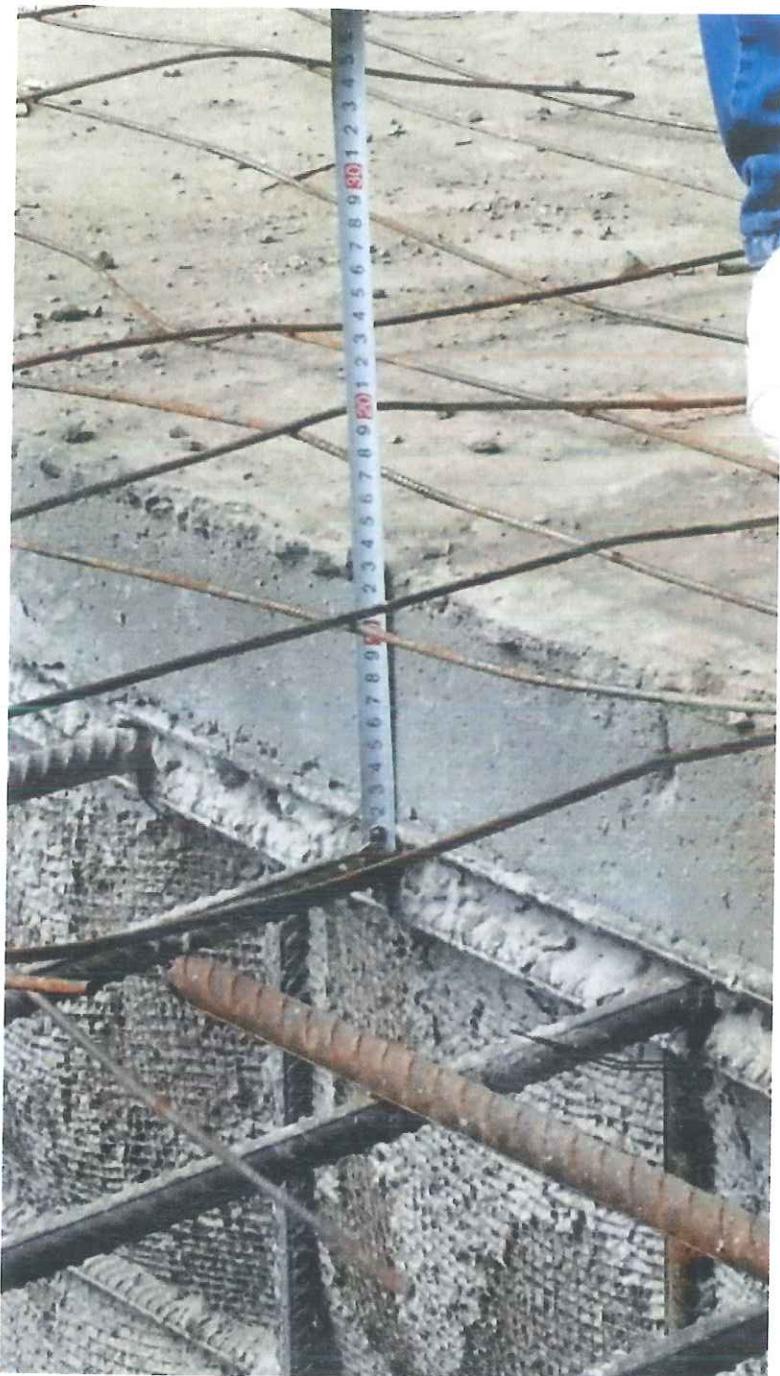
Западный слой бетона для верхней арматуры в фундаментной плите. По проекту 30мм, по факту 130мм.
